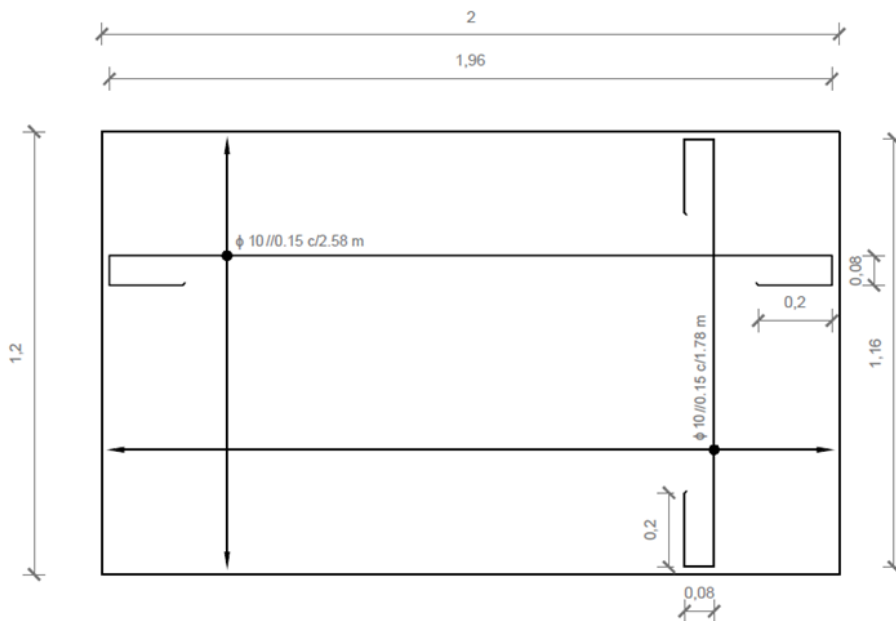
Planta maciço e disposição dos protótipos, dimensões em (m)
